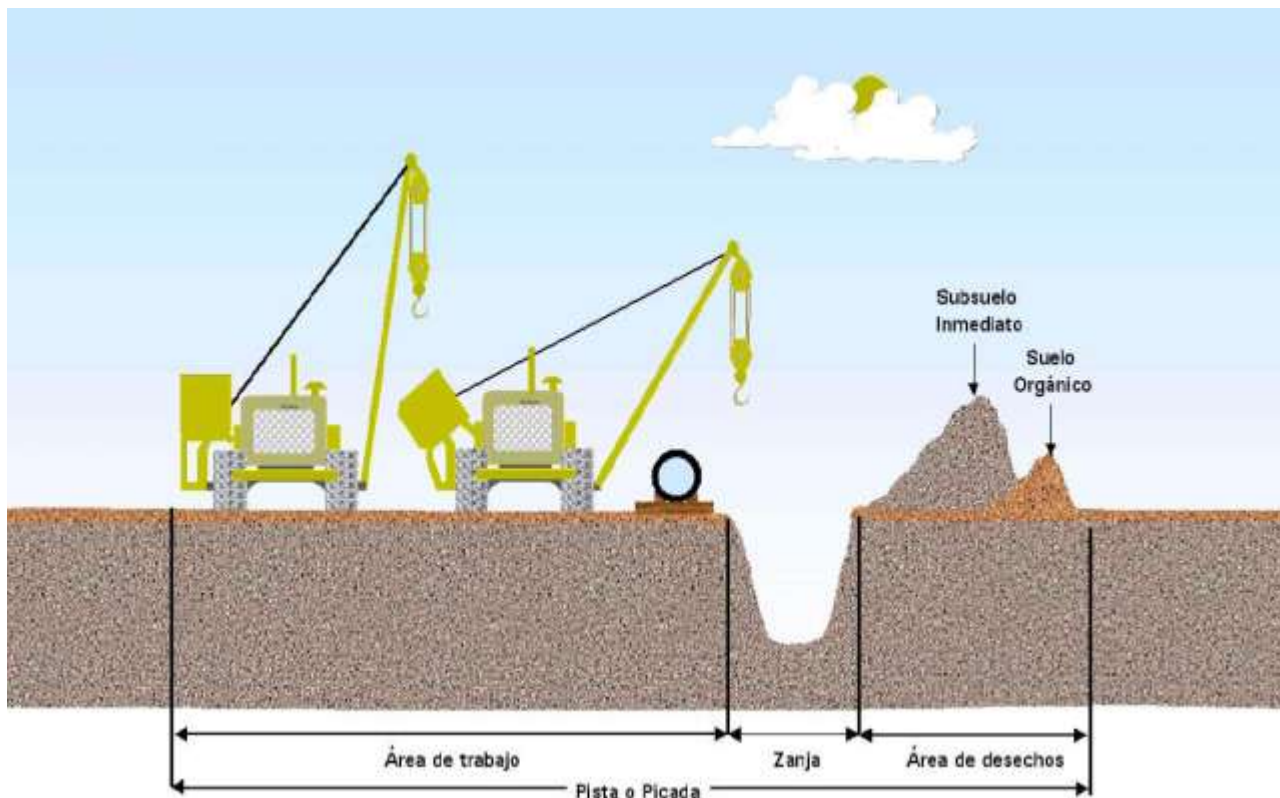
Esquema de apertura de zanjas. Corte transversal del terreno.
